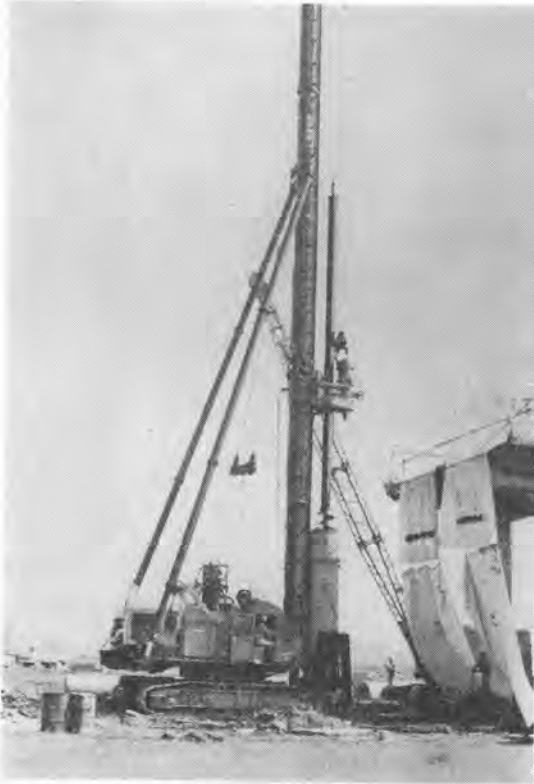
日本鉄道建設公団武蔵野線新河岸高架橋基礎大径 P C ぐい (1,000 φ) の施工状況
